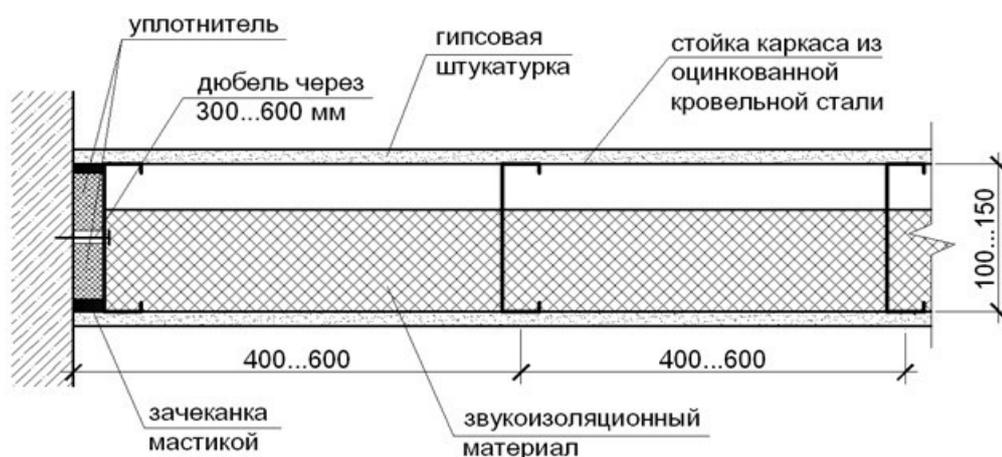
Узел крепления перегородки из гипсокартона к стене
